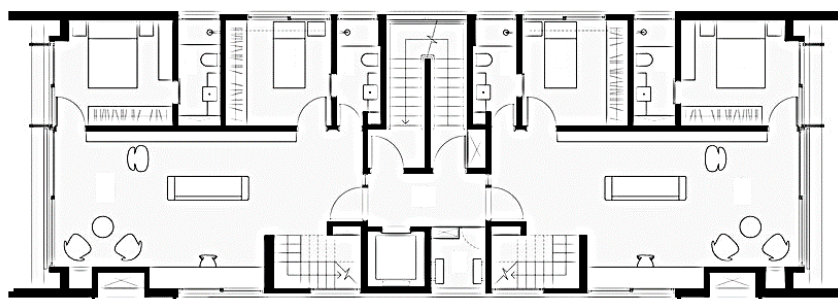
Ed. Praça Municipal 47, pavimento tipo, dois apartamentos por andar.
